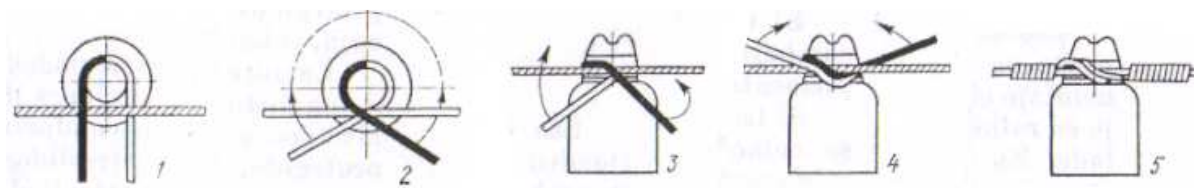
Sujeción del cable conductor al aislador en estructuras angulares⁷
